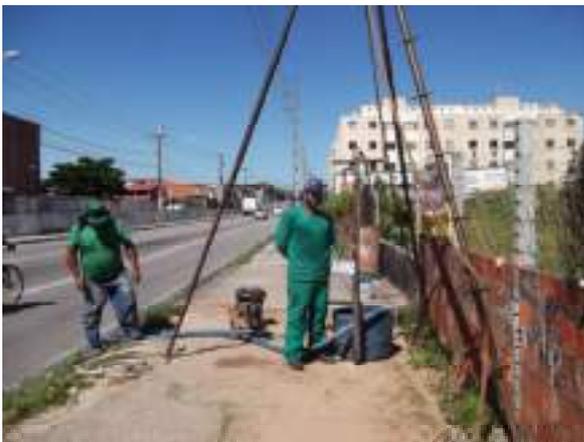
Detalhe da identificação do furo SP-04 da Travessia do Plano CE-09.
